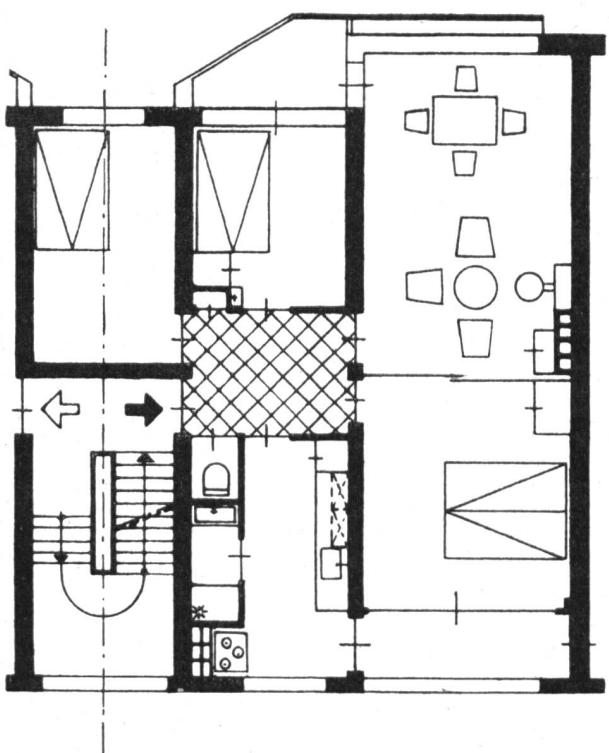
Normalgrundriss des viergeschossigen Mietshauses (Abb. 2). Wohn- und Schlafzimmer können durch öffnen der Schiebwand in einen durchgehenden Raum zusammengefasst werden.
